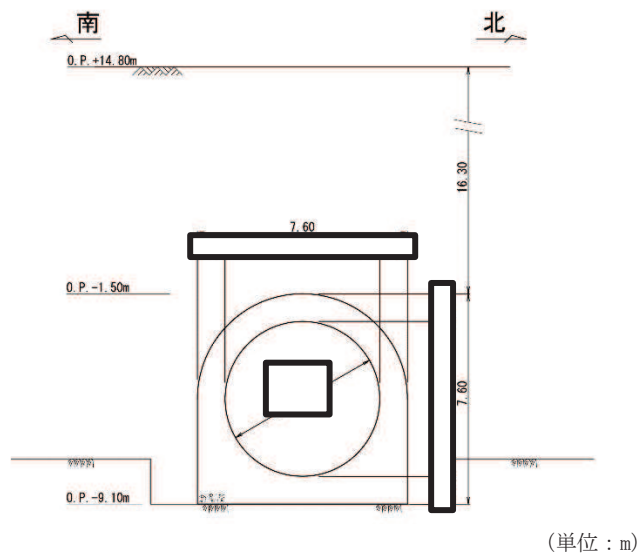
(1) 排気筒連絡ダクト断面図 (A-A 断面, 土砂部)
